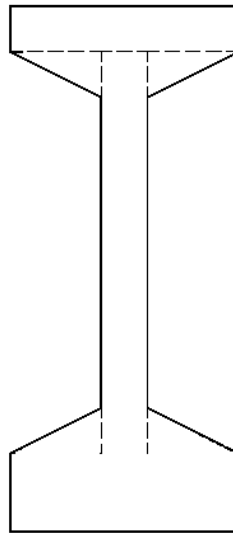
Tipo de viga 1, utilizada en tramos rectos. Fuente:
